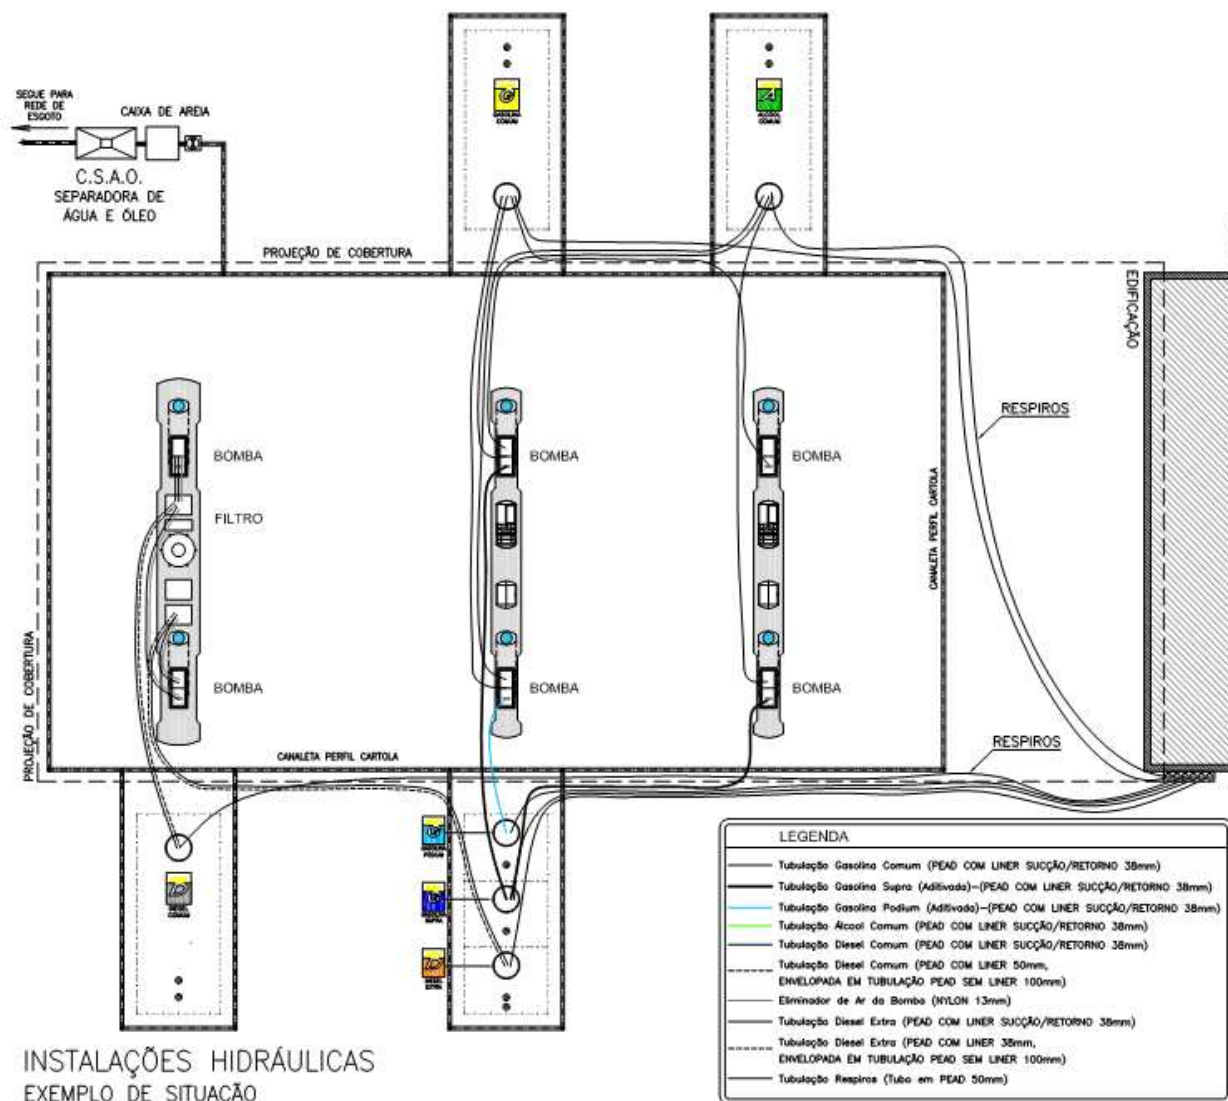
Projeto Hidráulico. Fonte: Manual de Instalação.
